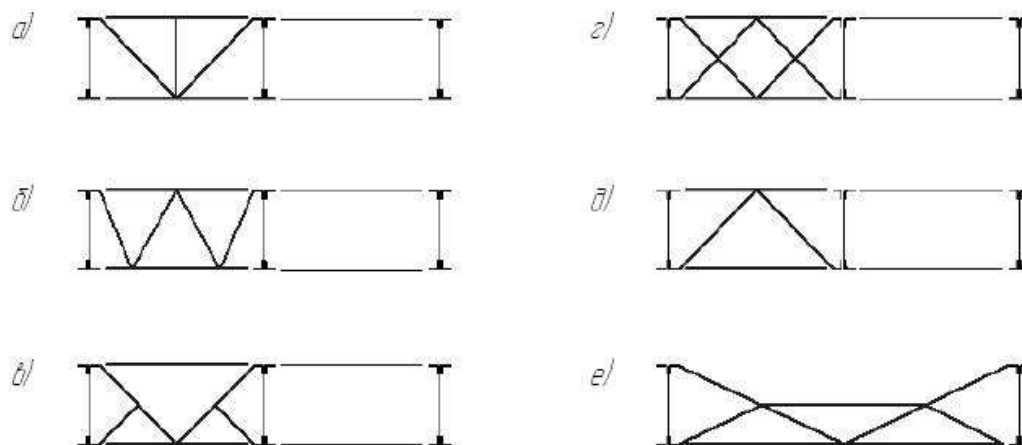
Схемы решеток вертикальных связей между фермами
